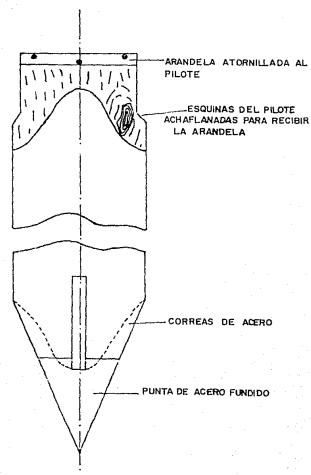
PROTECCIONES PARA CABEZA Y PUNTA DE UN PILOTE DE MADERA.
